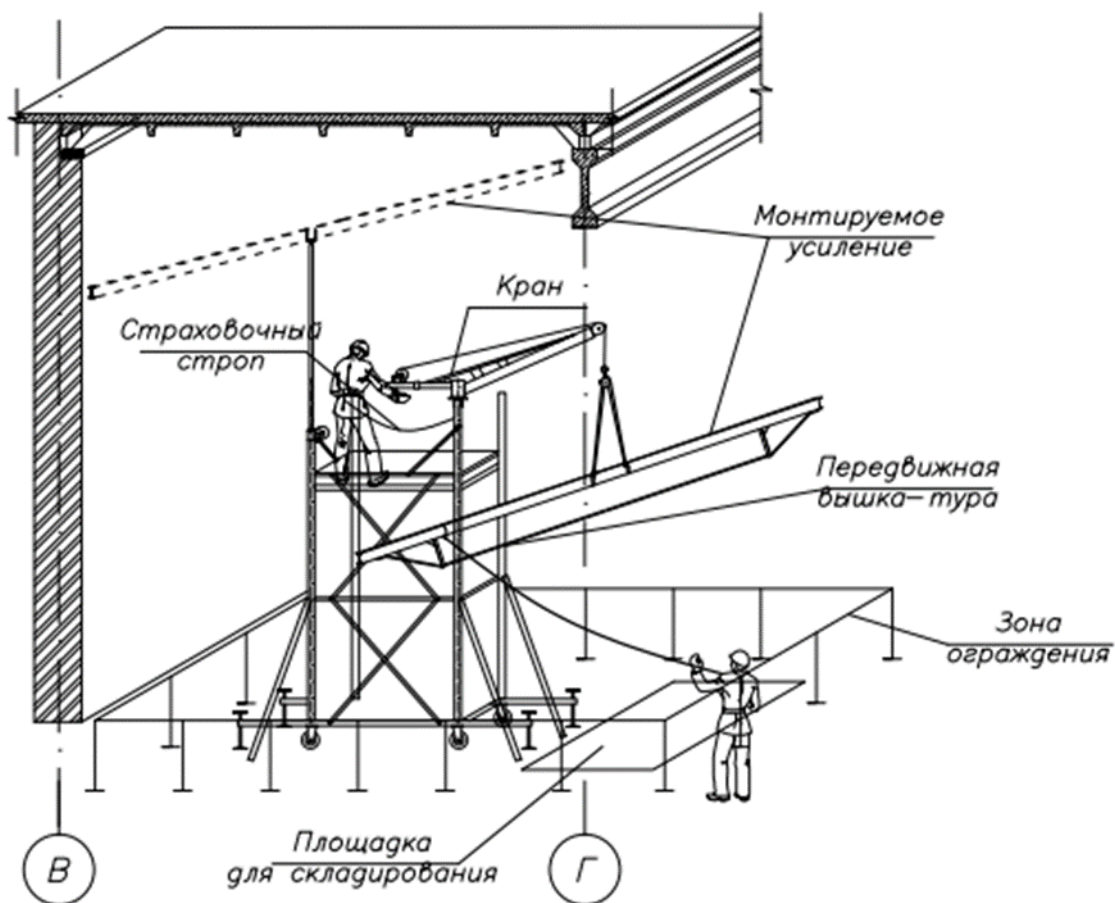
Организационно-технологическая схема безопасного монтажа стальной балки-шпренгеля для усиления железобетонных конструкций покрытия с использованием модернизированной вышки-туры
